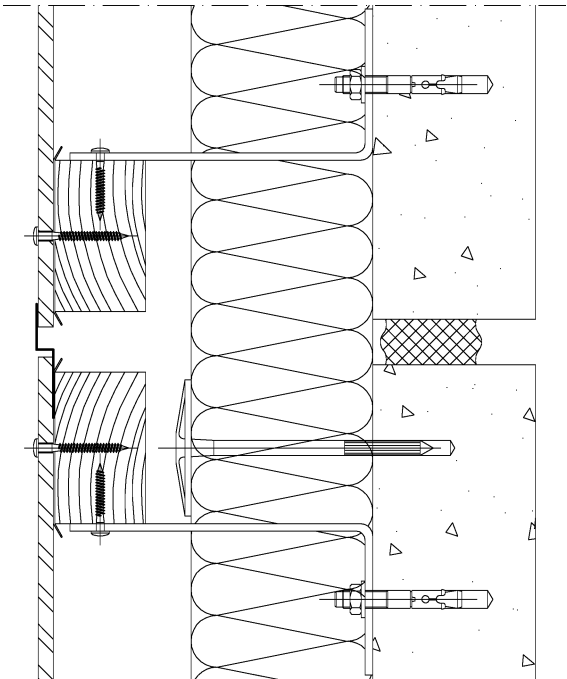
Sección horizontal. Perfil auxiliar entre paneles para junta de dilatación vertical.
